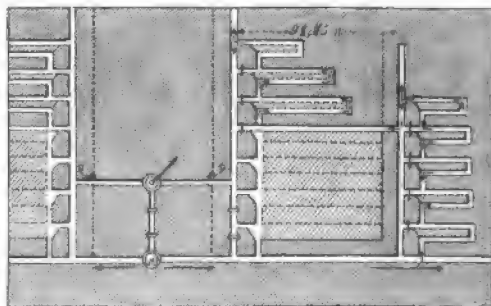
Streichender komb. Streb- und Pfeilerbau in Wales.
